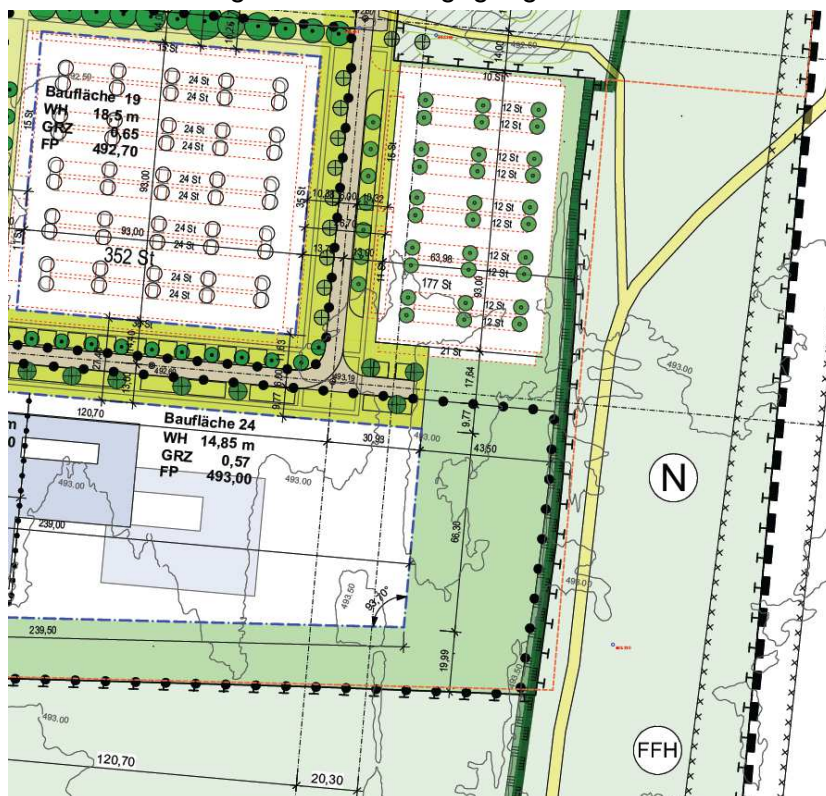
Ausschnitt B-Plan-Änderung im Bereich von Baufläche 24 (Architekten Stadtplaner BDA Franke und Messmer PARTGMBB)
